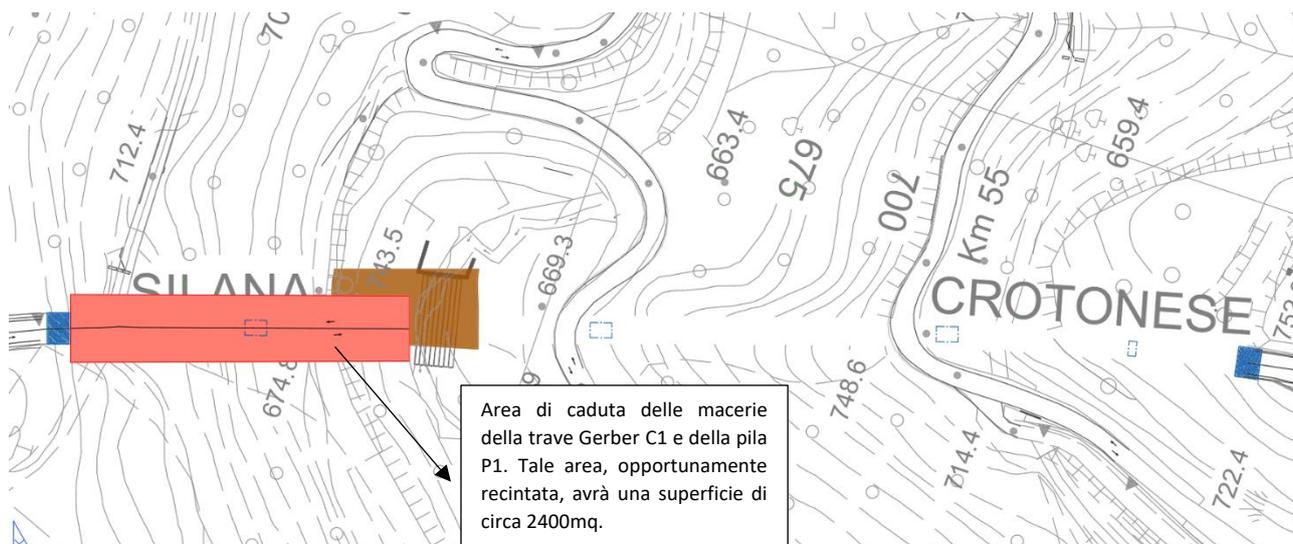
Estratto elaborato V382026002APA “Tavola della fasizzazione dell’intervento di demolizione (5 di 5)”
